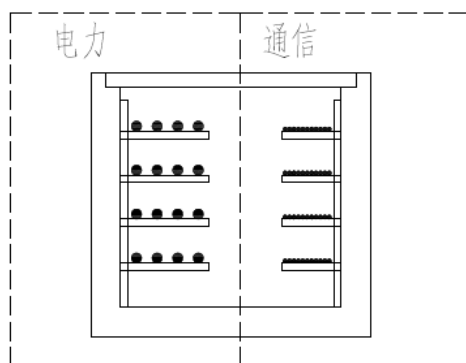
水平组合布置缆线沟 (B 型)
